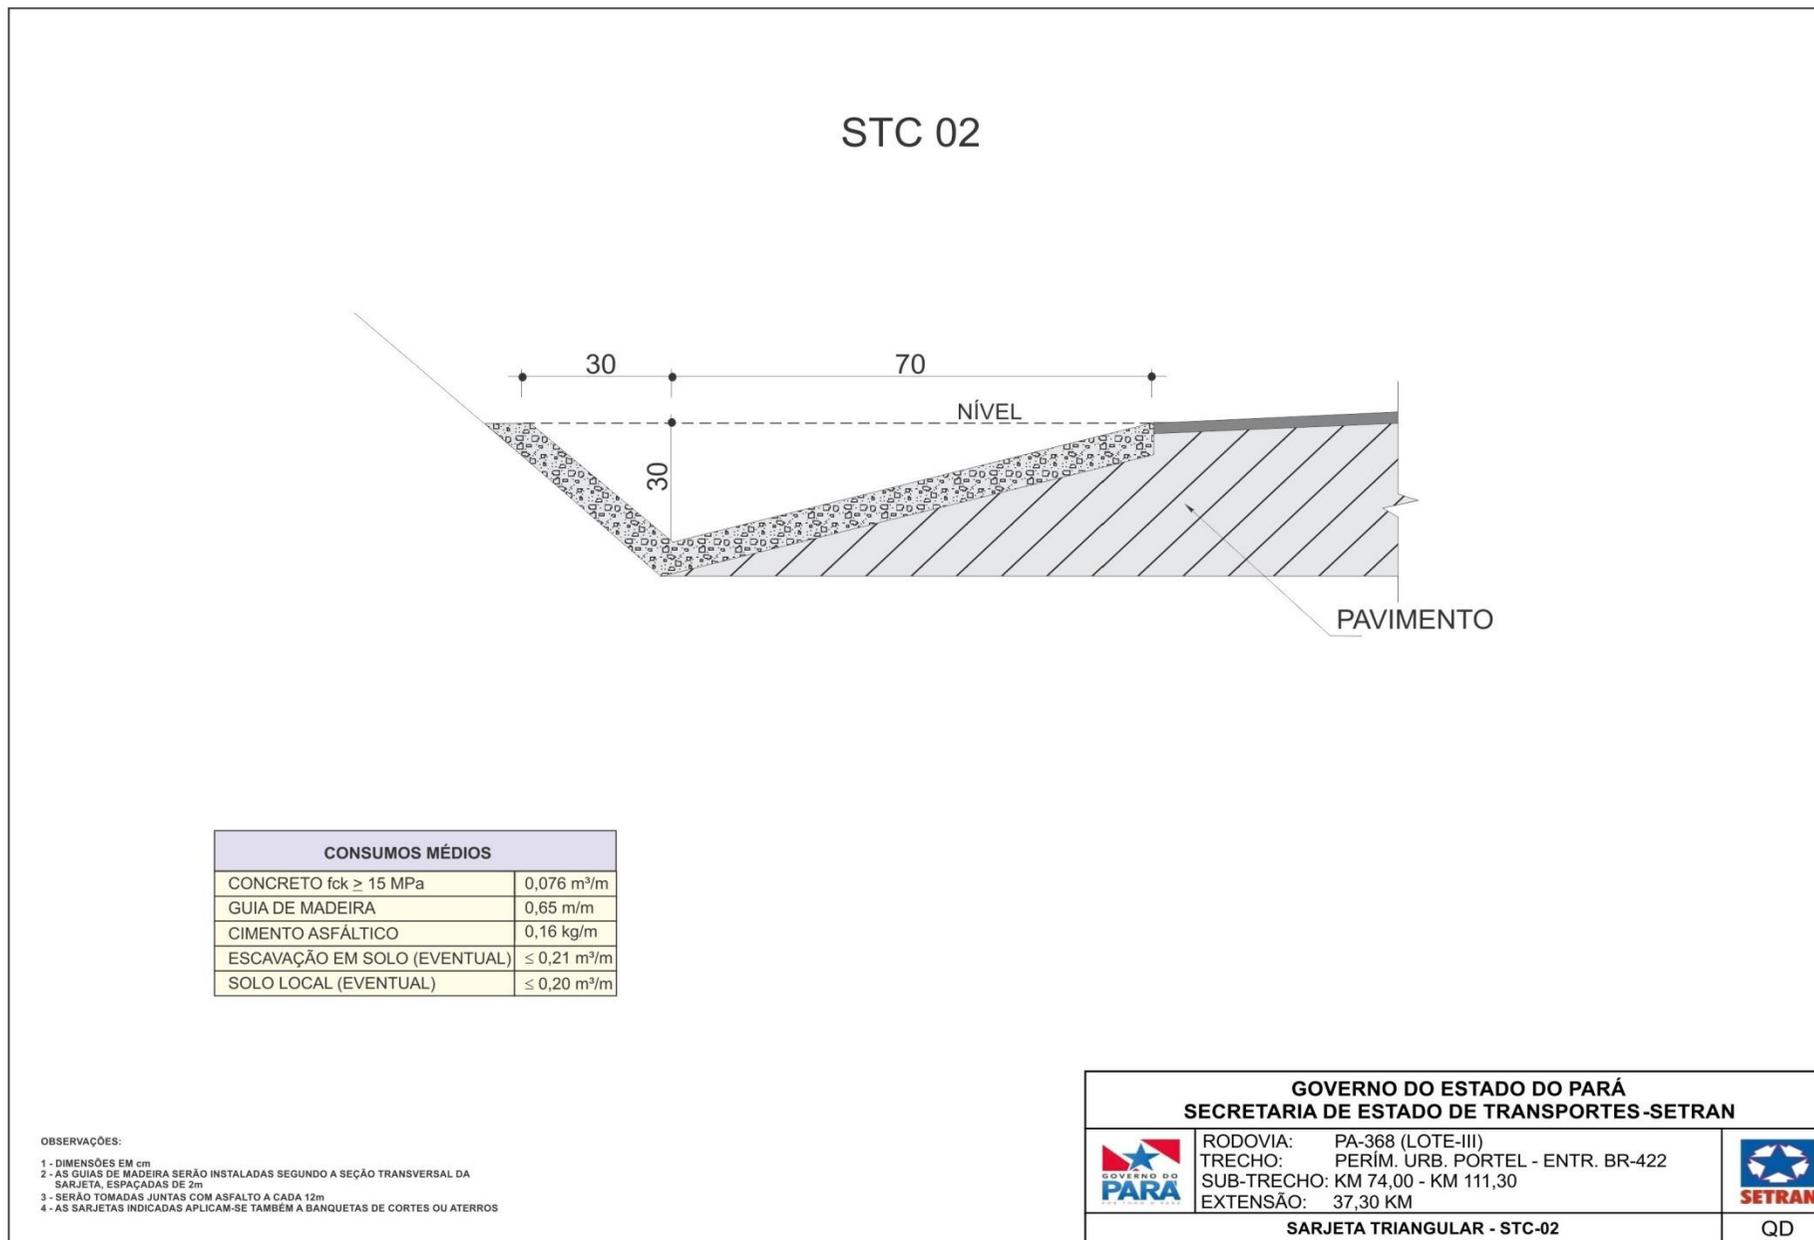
Sarjeta Triangular de Concreto – STC-02
